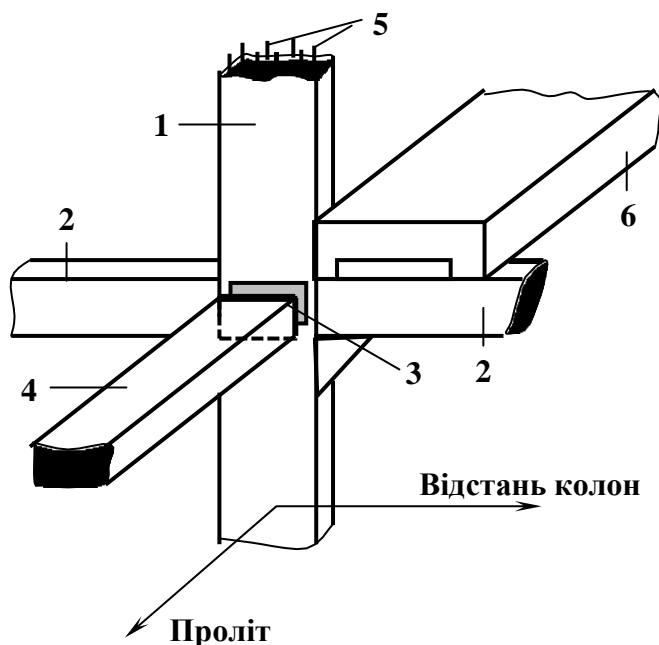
Фрагмент будівельної конструкції: 1 – колона; 2 – ригель; 3 – закладний елемент; 4 – прогін; 5 – арматура; 6 – плита перекриття.
